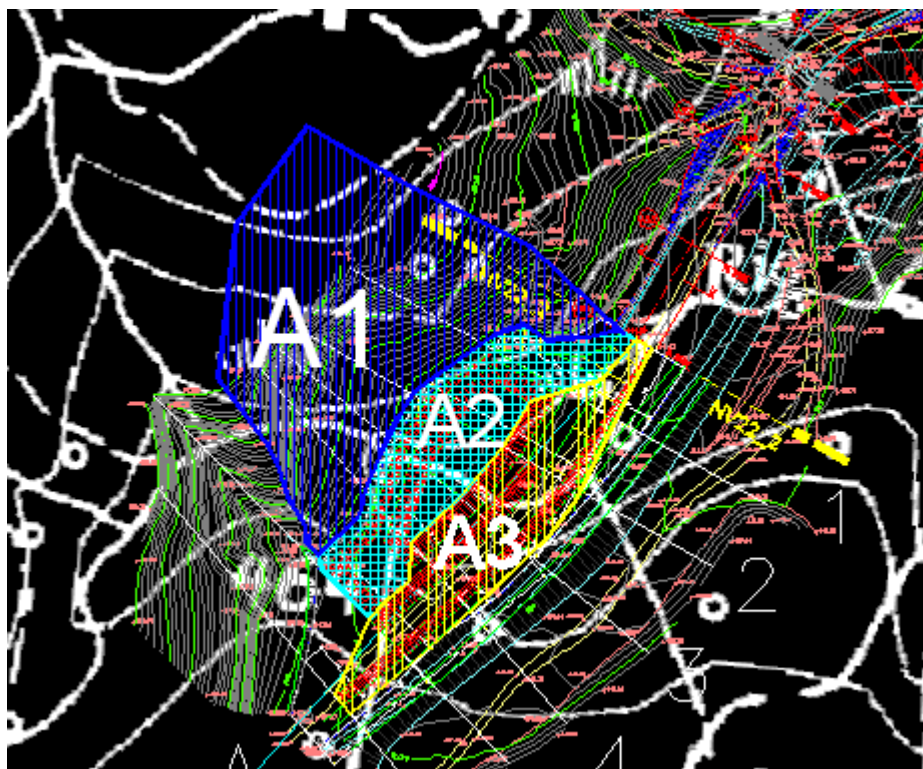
individuazione aree idrauliche sottese dalle canalette deposito
